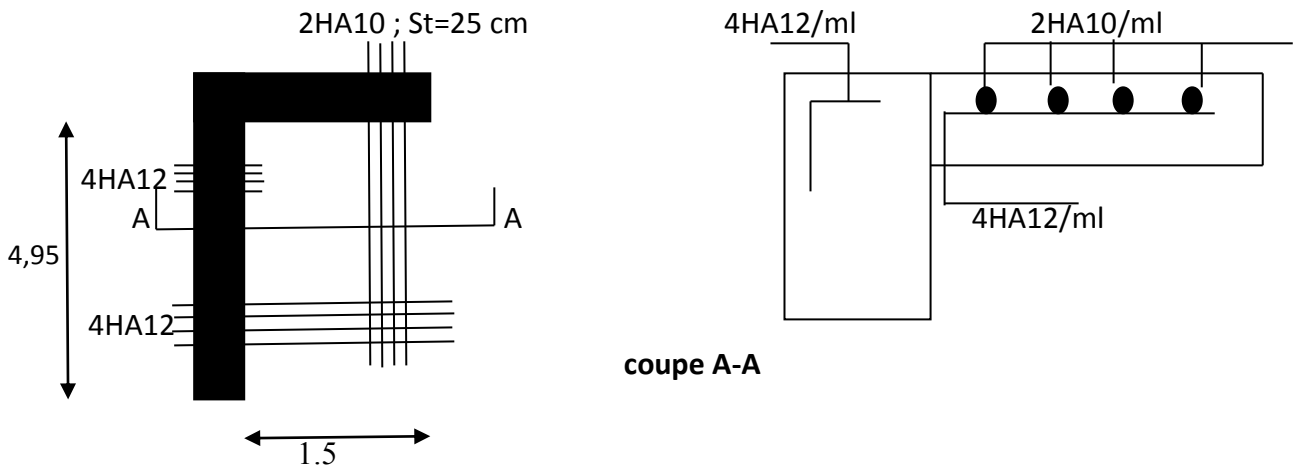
Schéma de ferrailage de la dalle sur 2 appuis(RDC)
